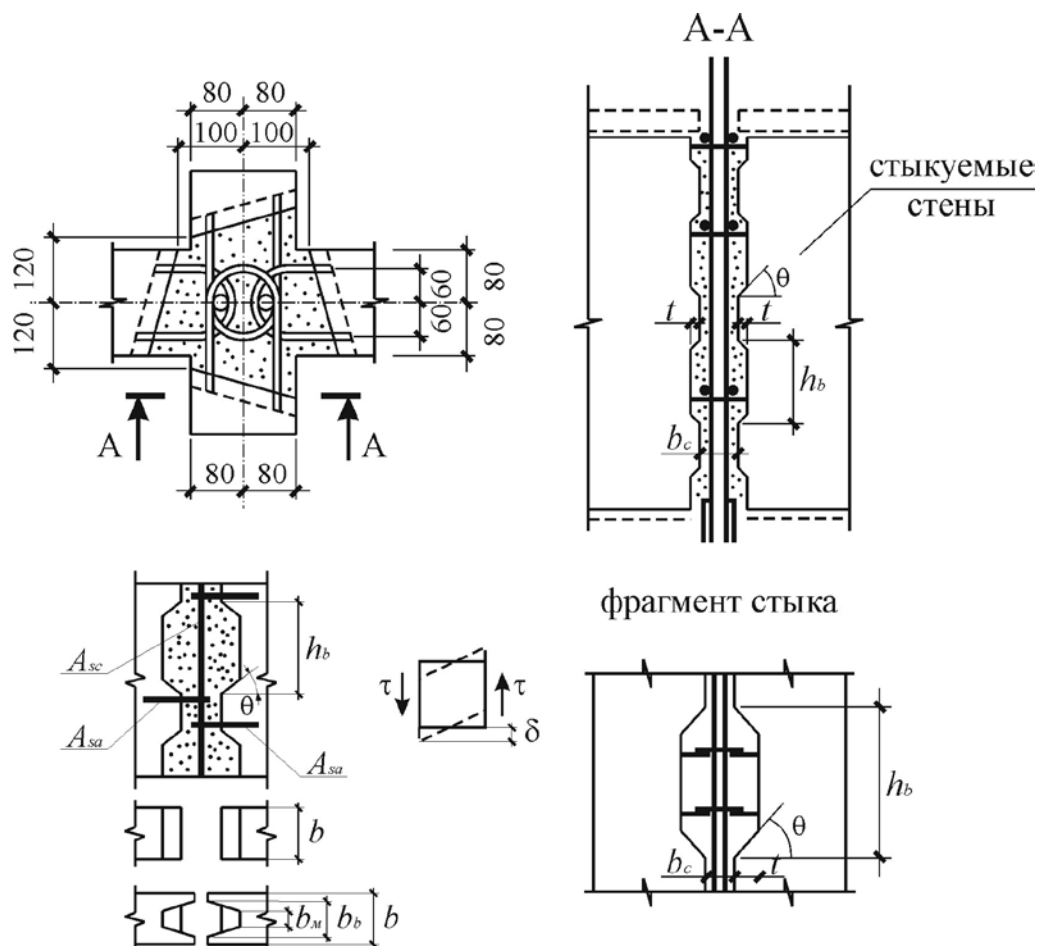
Схема армирования и конструирования вертикального монолитного стыка стен
